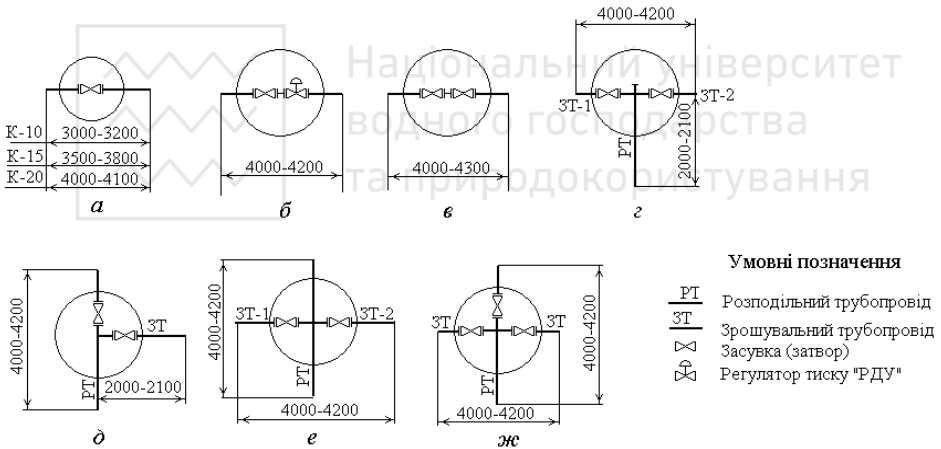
Габаритні схеми вузлів на зрошувальних трубопроводах:
